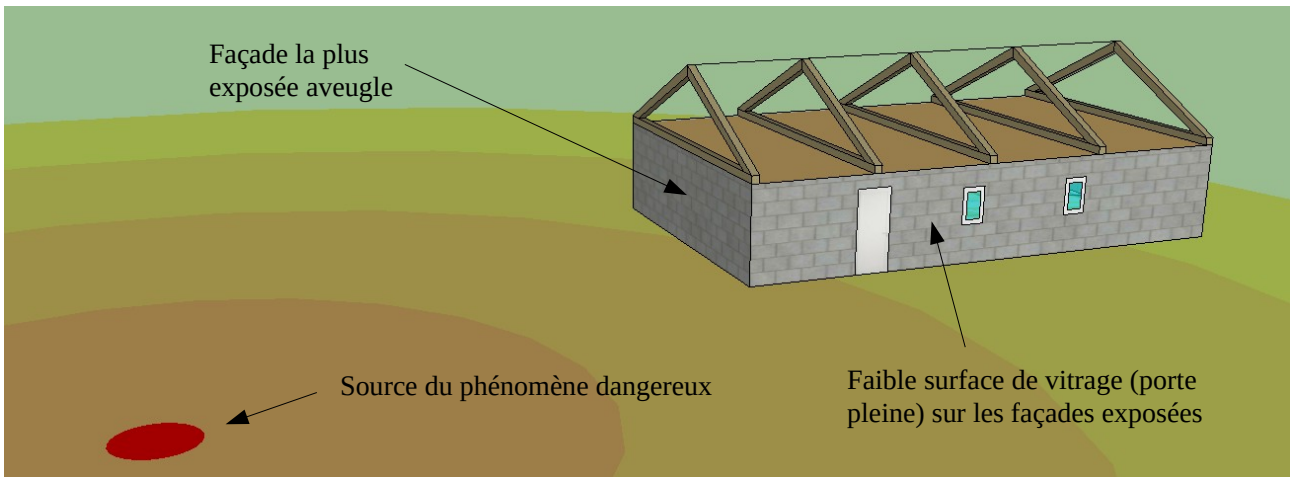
Exemple d'implantation des menuiseries vitrées sur les façades exposées
